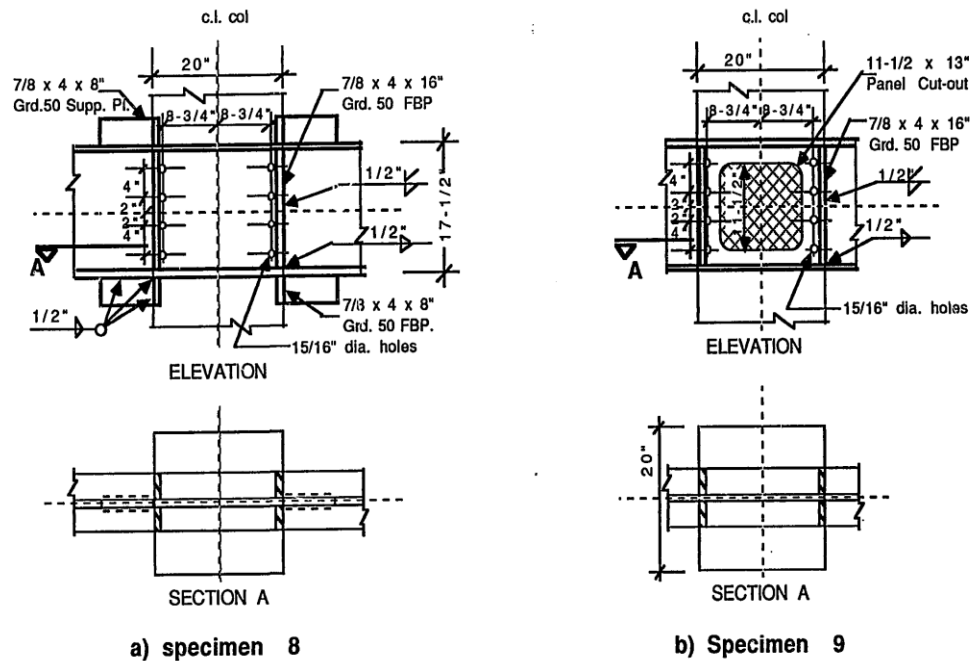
Detalles de las vigas en el área de la junta: a) para la muestras 8, b) detalle para la muestra 9. Nota. Shikh muhammad t. momento connections between Steel beams and concrete columns (1987) (pág.47)
